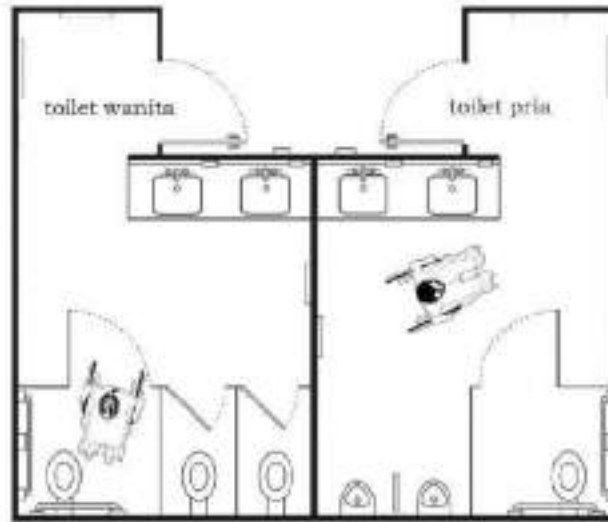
Denah ruang dalam toilet untuk umum dan anak-anak
